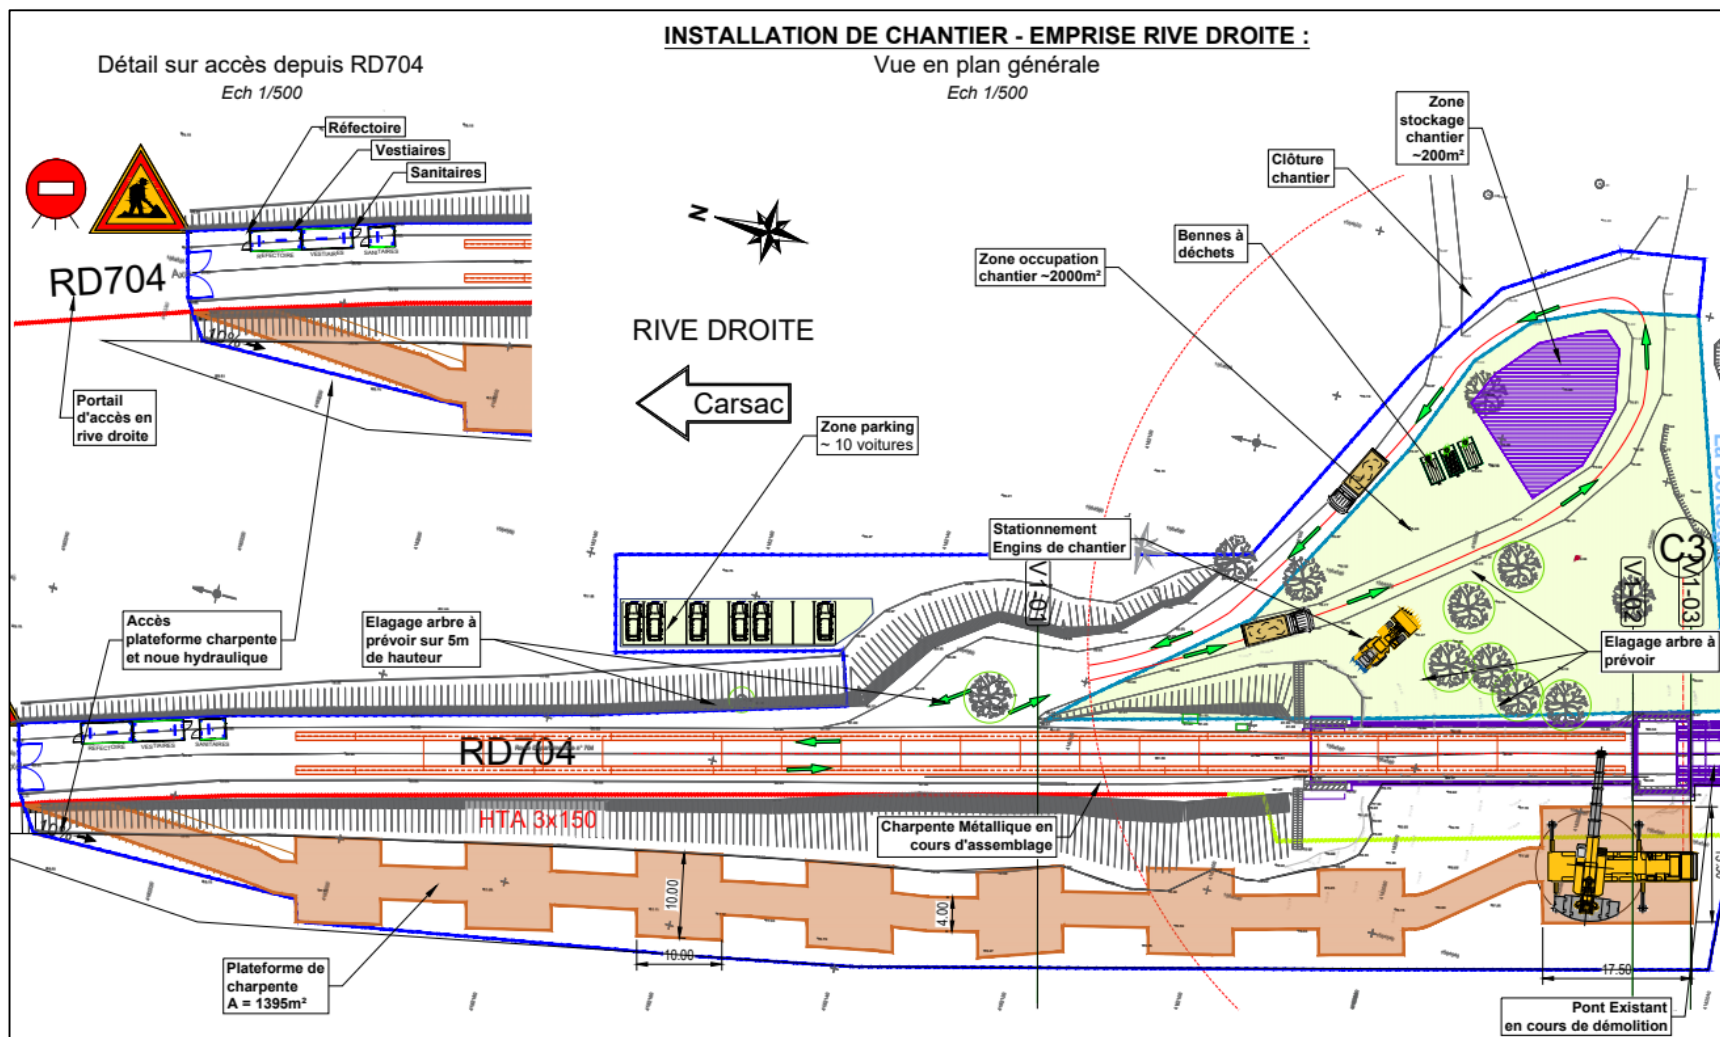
Plan de circulation sur le site d'étude en rive droite (Source : NGE)
